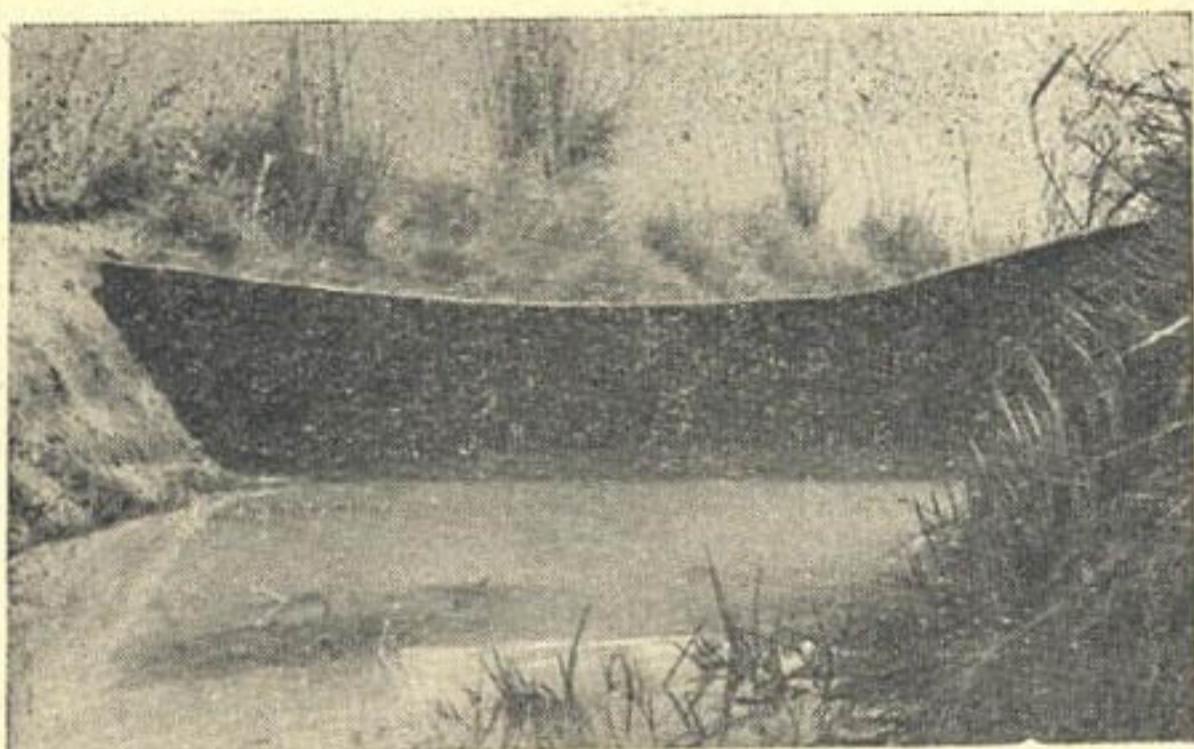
Гибкая перемычка шириной 8 м на водоотводящем канале; вид со стороны нижнего бьефа.
